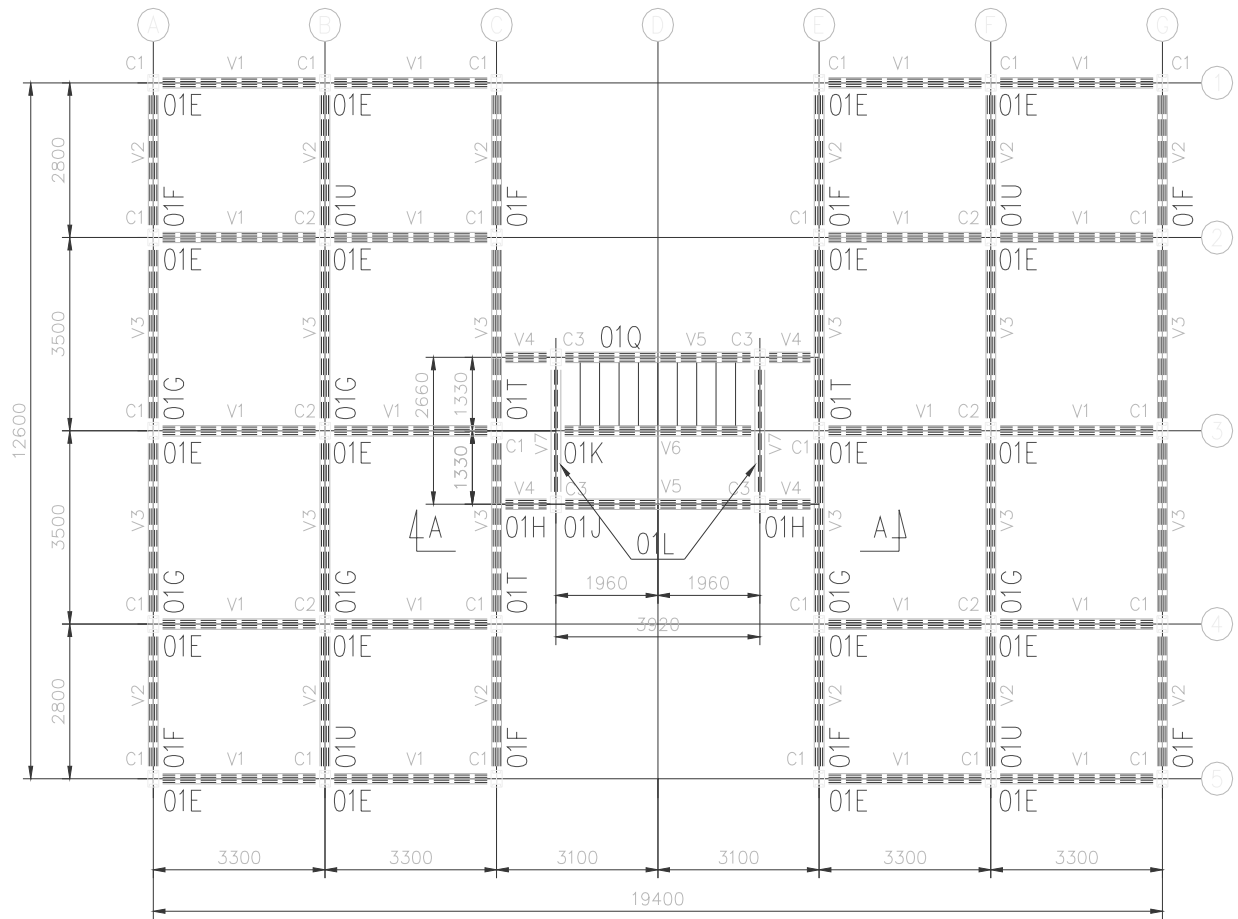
Plano de vigas do pavimento tipo – arquitetura tipo “A”
